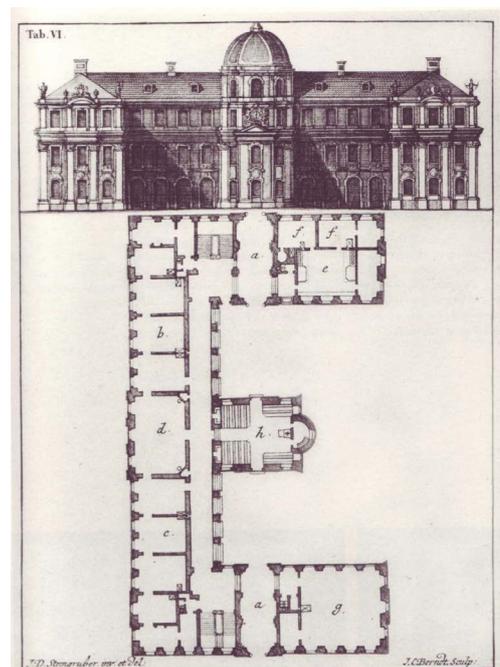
J. D. Steingrüber, alzado y planta de la letra E.
